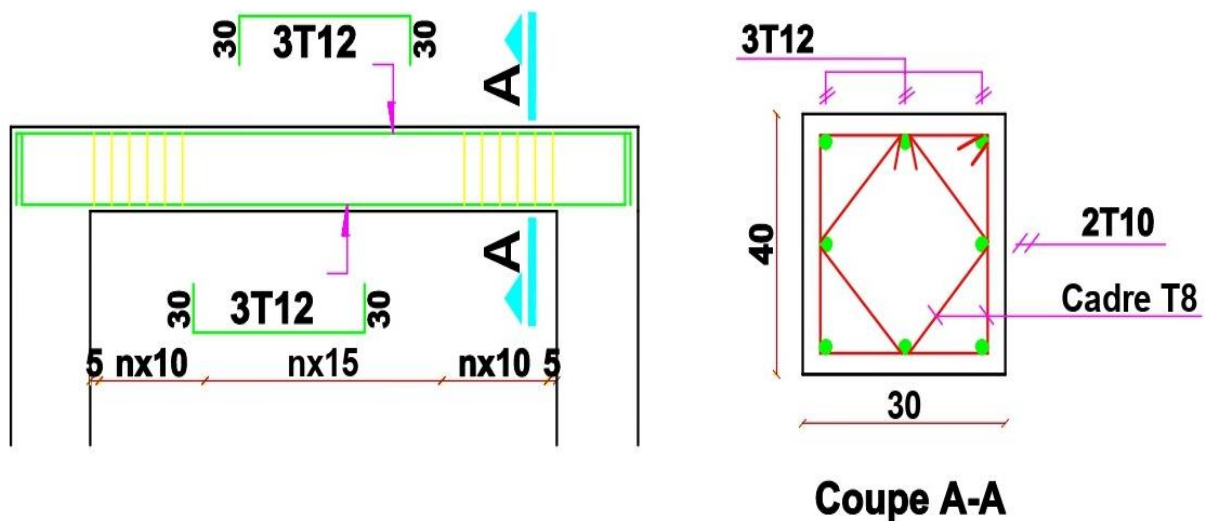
Schéma de ferraillage de la poutre palière
